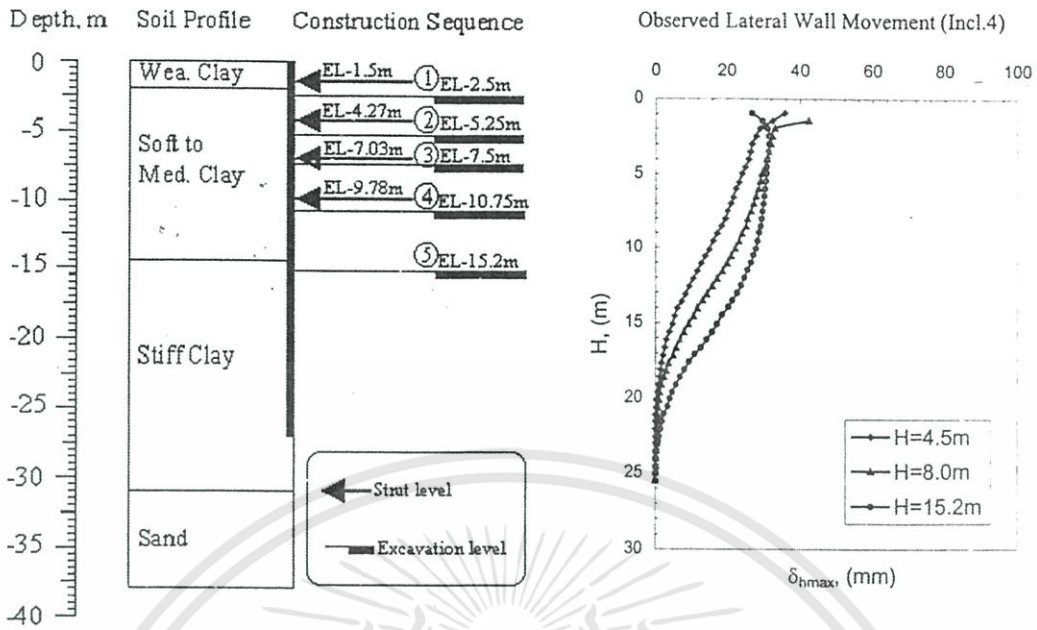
Case No.1-BU-Bangkok United Insurance Building Project
